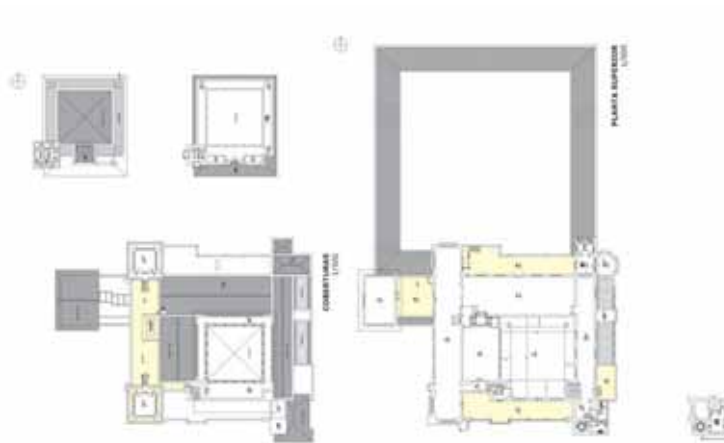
Plantas baixas pavimento superior e mezanino; Planta de cobertura (Fonte: Catavento Cultural e Educacional).
